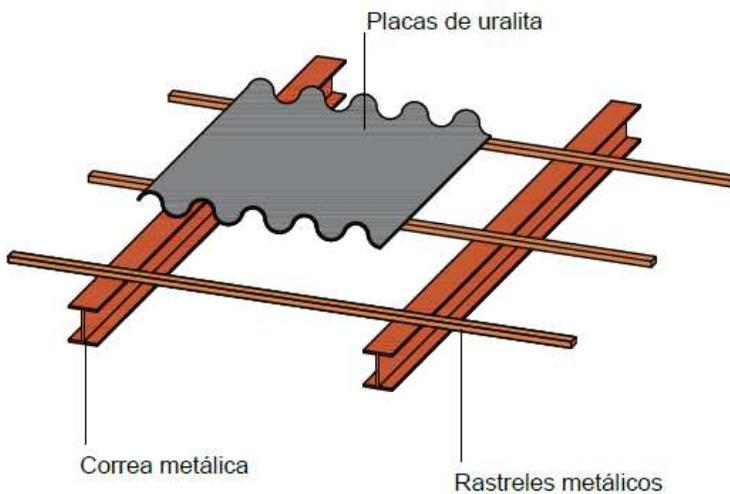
Detalle cubierta placas uralita. Autor propio
